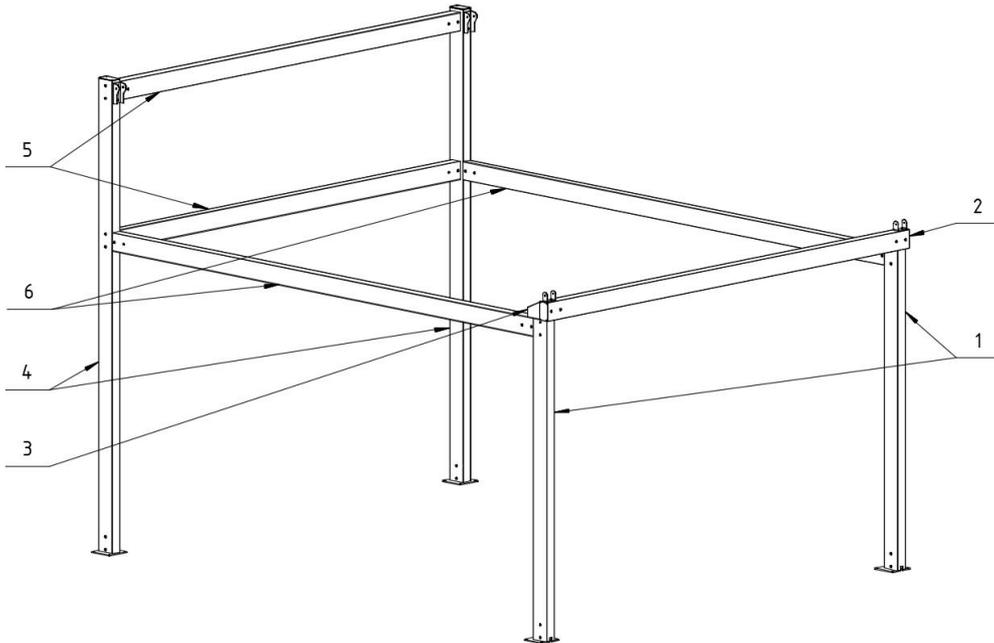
Construction porteuse: 1 - Poteau bas, 2 – Barre frontale, 3 - Gouttière, 4 – Poteau haut (droit, gauche), 5 – Barre arrière, 6 – Barre latérale.
